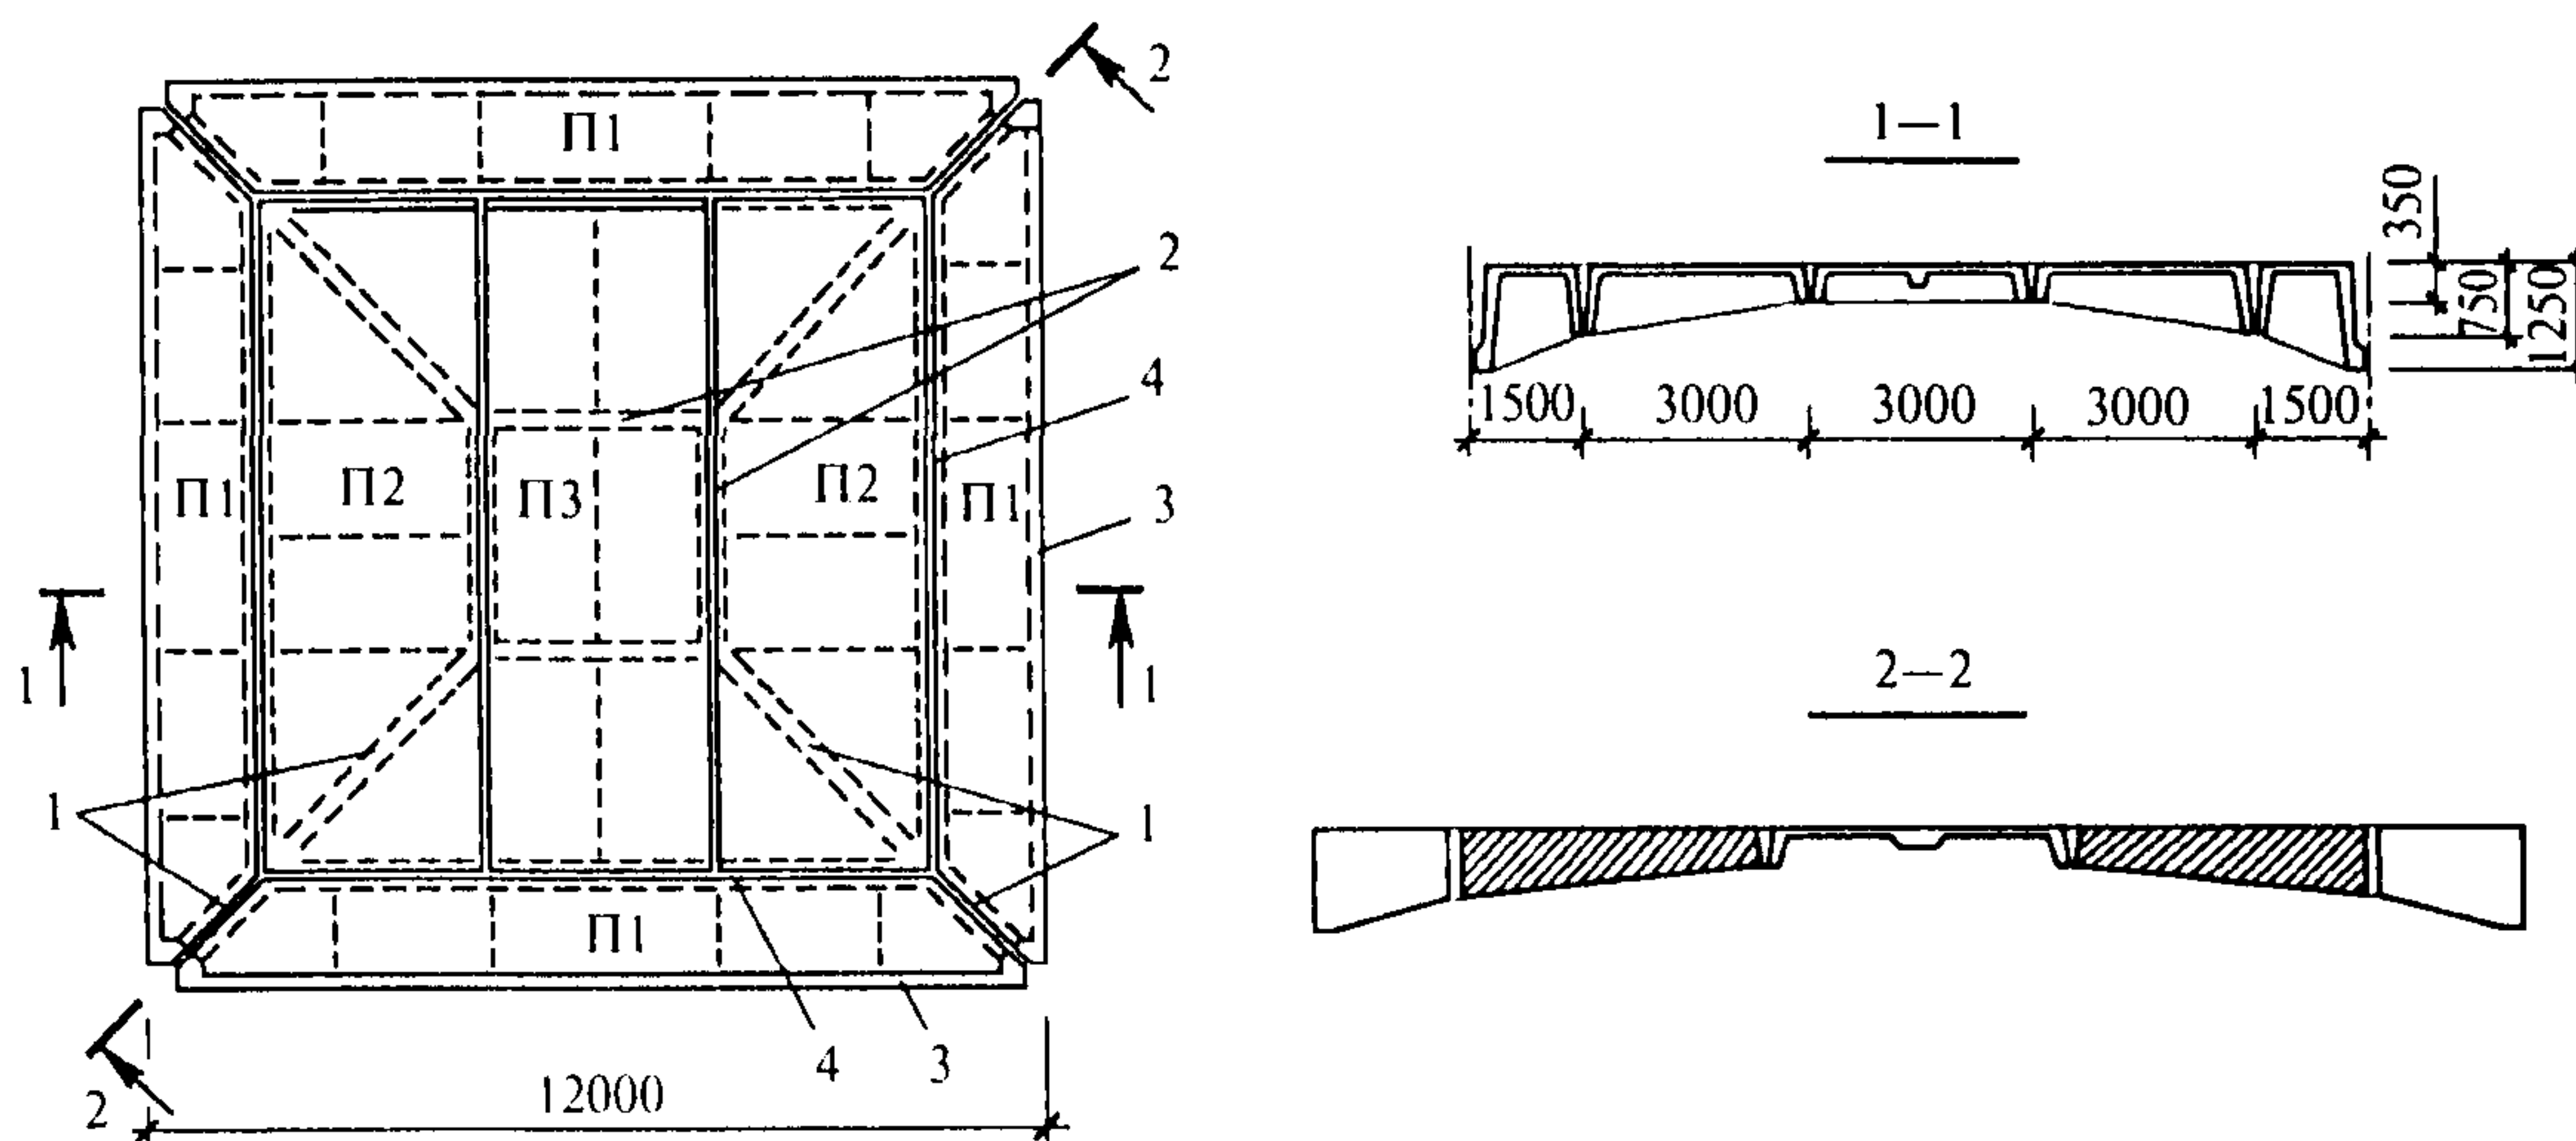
Геометрия сборного рамно-шатрового перекрытия
